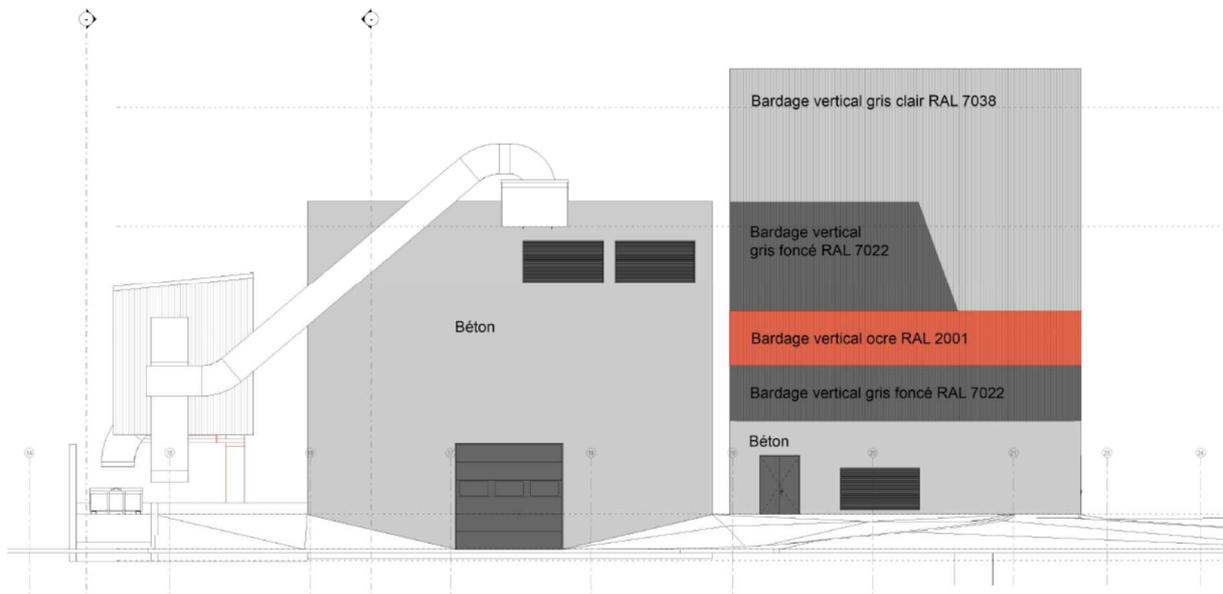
FAÇADE COTE CHAUFFERIE BIOMASSE DU PROJET.
